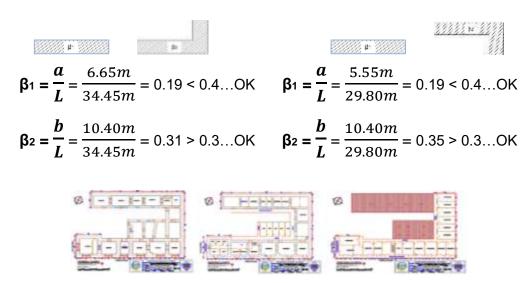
Vista del plano en planta del 1º, 2º y 3º piso del Hotel Palermo
